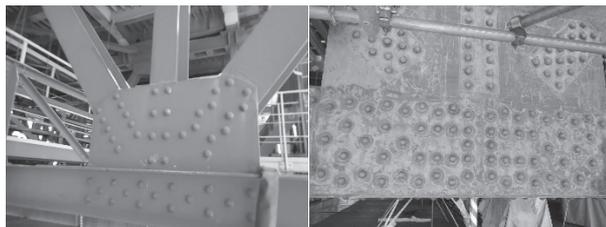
IH塗膜剥離の施工前(左)と施工後(右)
